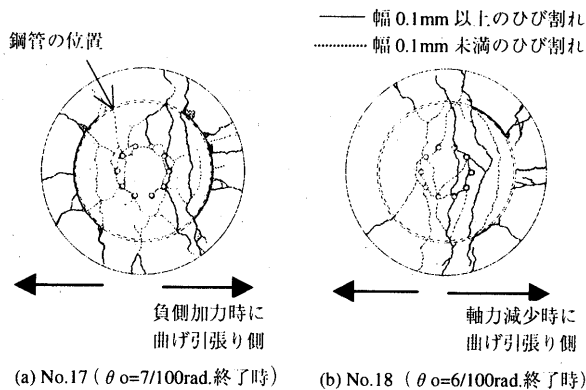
実験終了時の杭頭打ち継ぎ面のひび割れ状況
